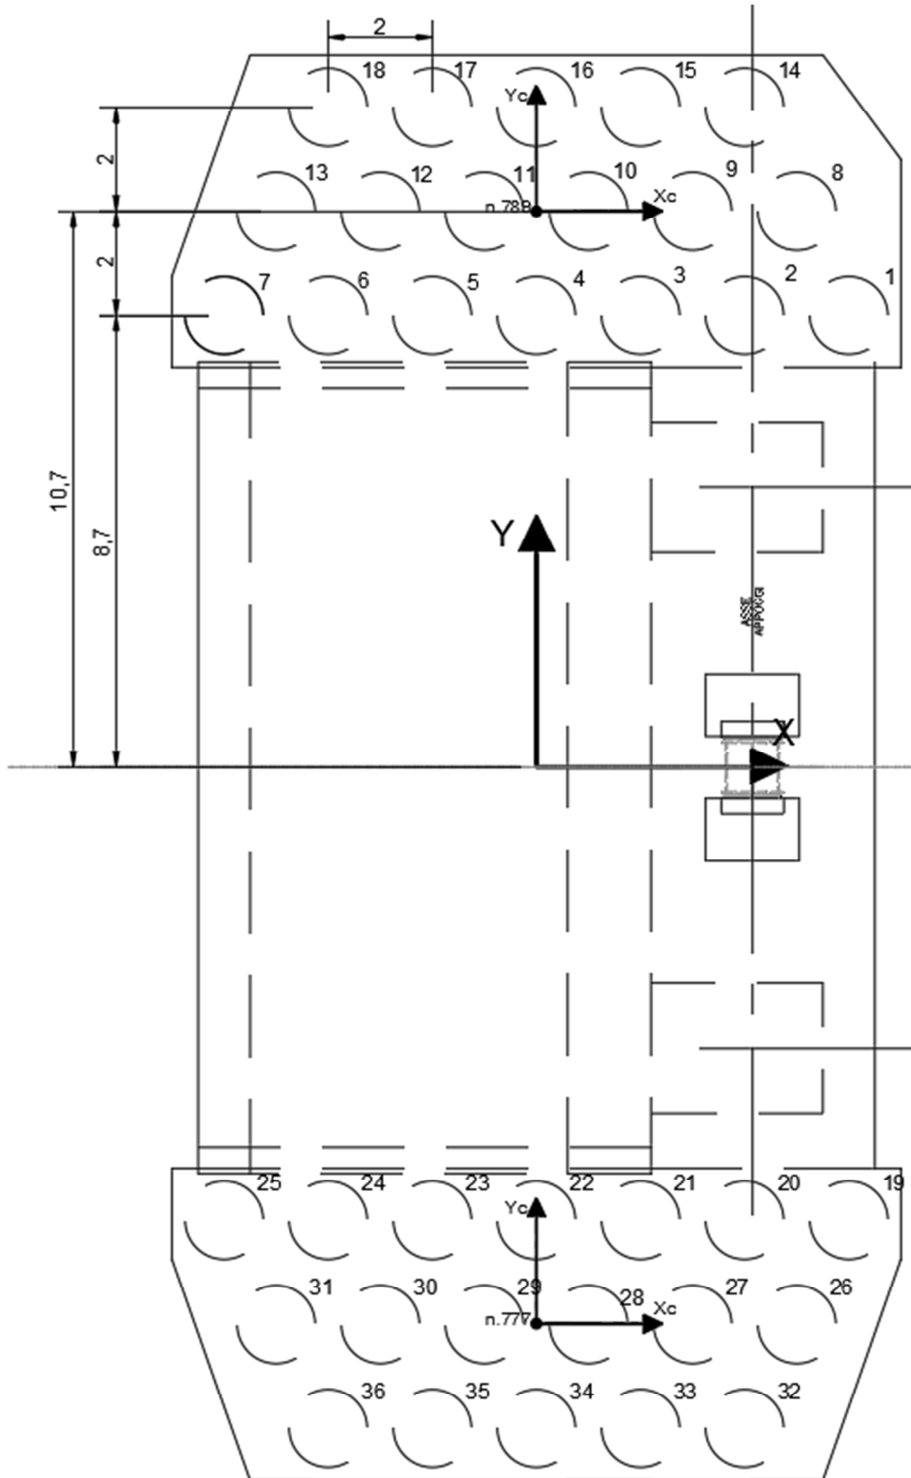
Pianta pali della fondazione spalla definitiva
